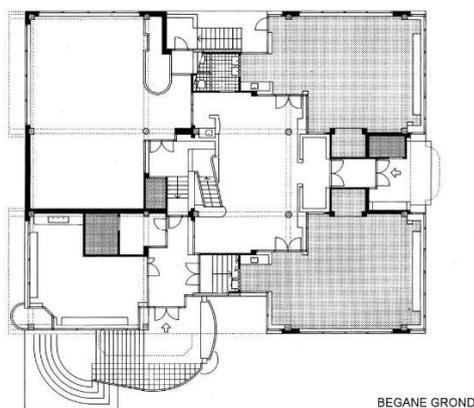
Vista e pianta del piano terra delle Scuole gemelle Montessori e Willemspark, Olanda Apollo Schools-Montessori School and Willemspark School, Amsterdam <https://www.ahh.nl/index.php/en/projects2/9-onderwijs/113-apollo-schools>
